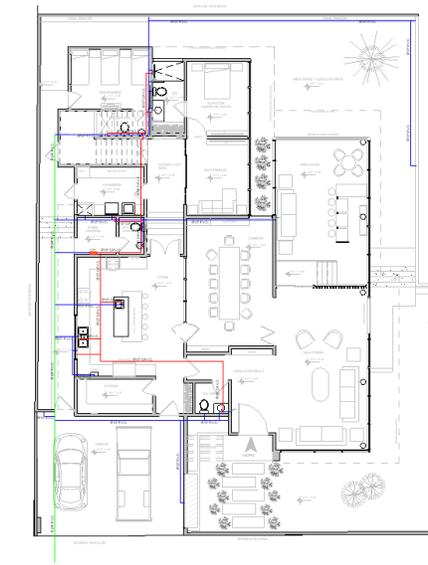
Plano hidrúlico primer nivel casa Bella Vista
